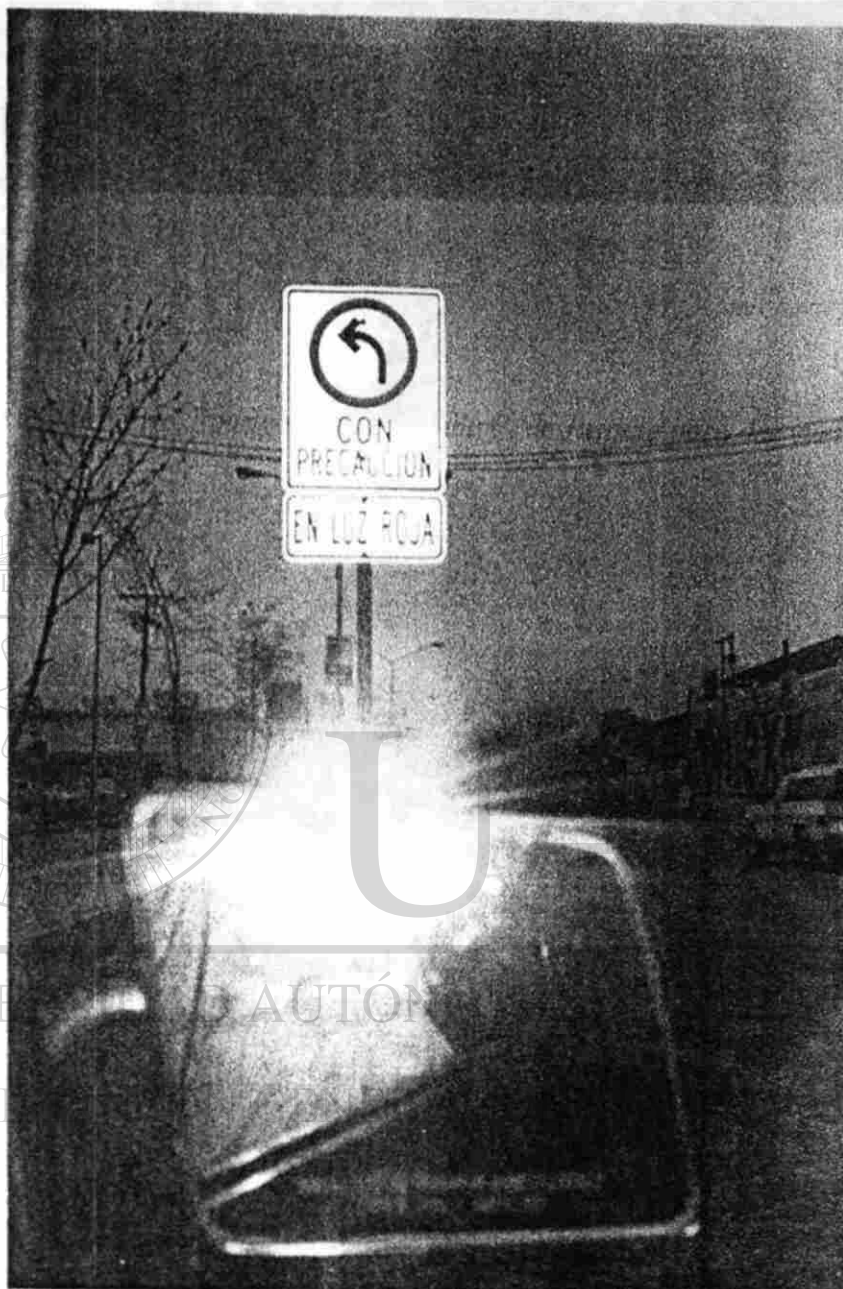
Señalamiento en Prol. Rodrigo Gómez y calle P. de Justicia para dar vuelta izquierda en rojo
